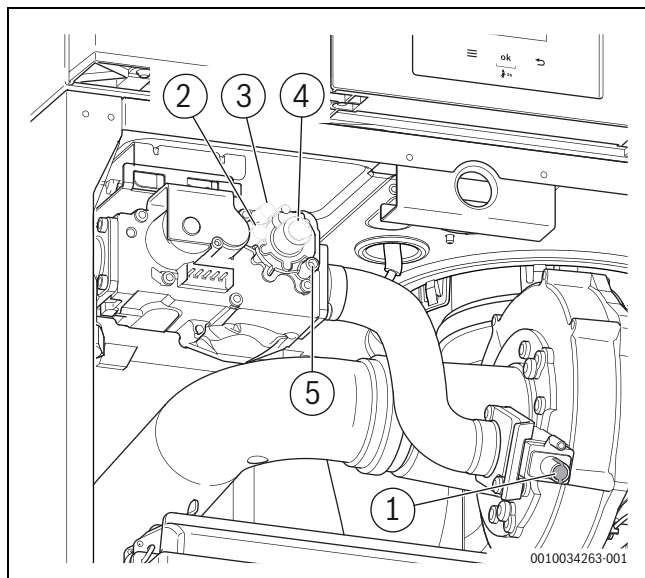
Vue d'ensemble des tubulures de mesure et des vis de réglage ≥ 85 kW
